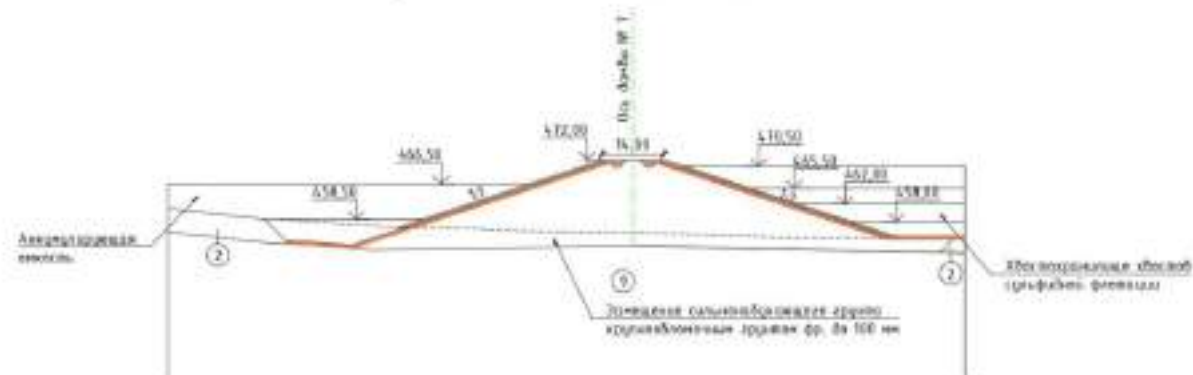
Расчетное сечение 6-6 по дамбе № 7
